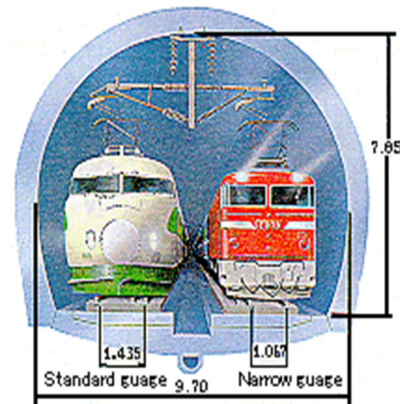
Proyecto ferroviario Túnel Seikan - Japón
